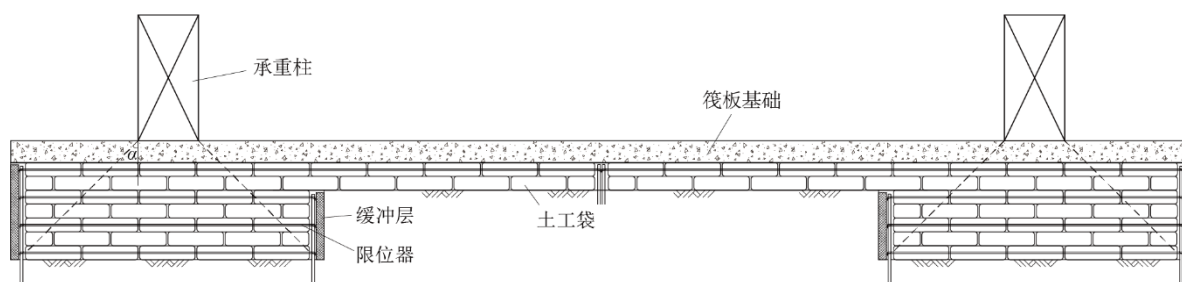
筏板基础下土工袋垫层布置示意图
